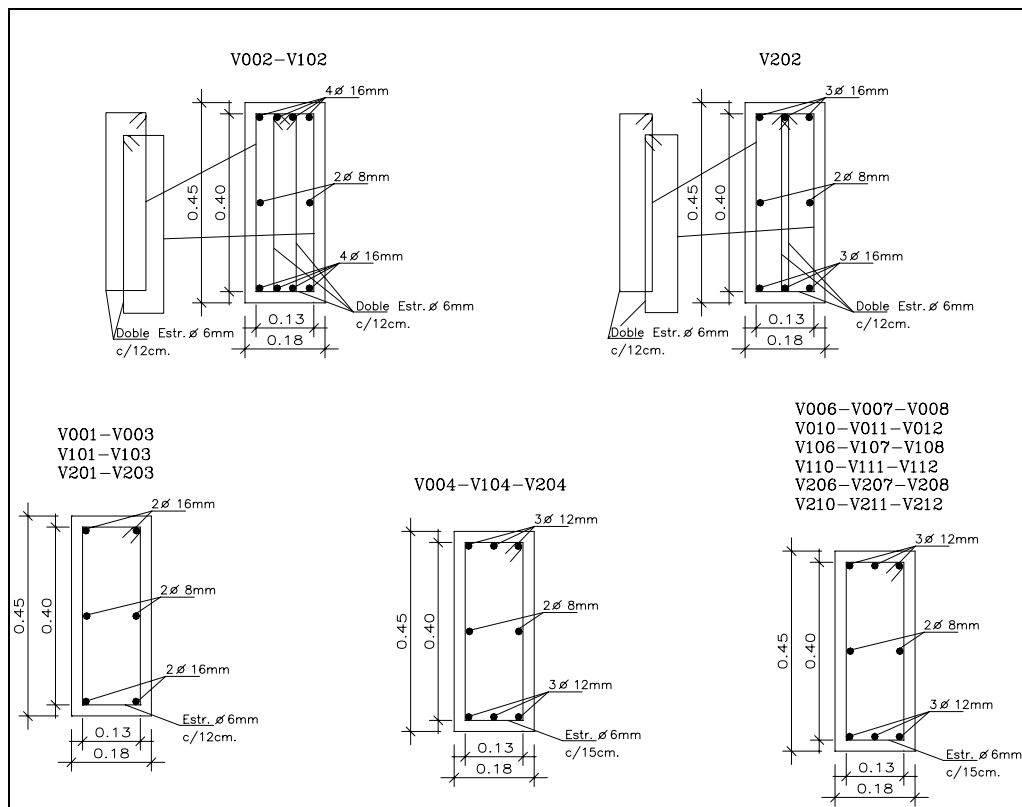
Detalle de disposición de armaduras en vigas de hormigón armado.
